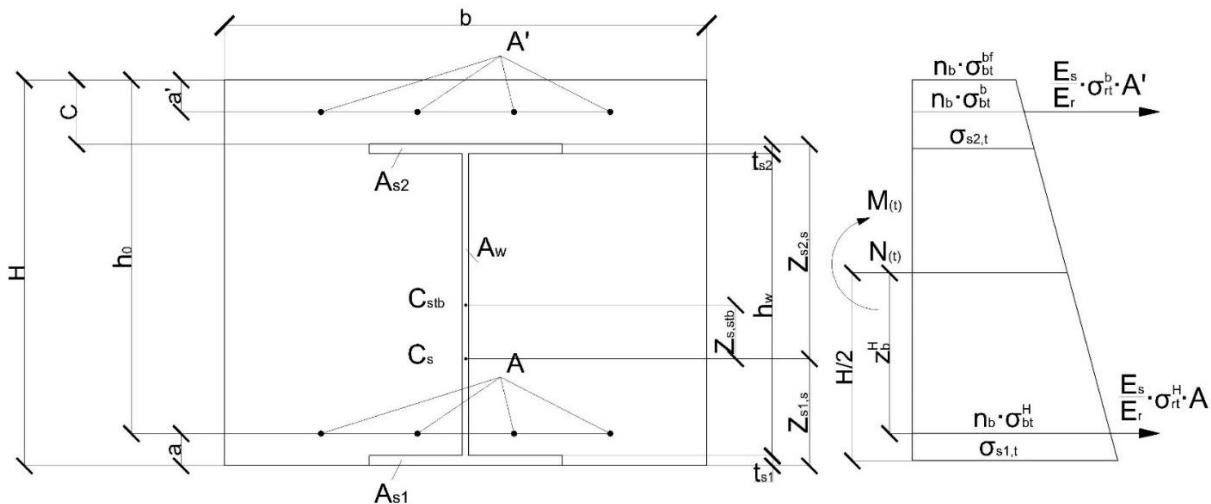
Напруження в сталезалізобетонному перерізі
